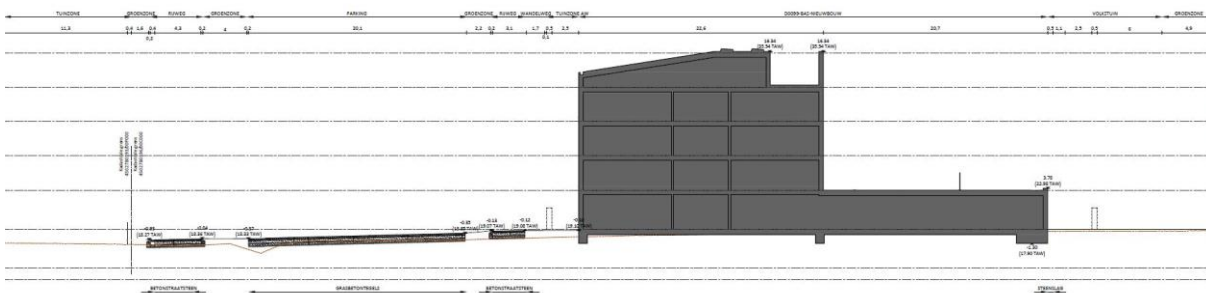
Plan van de geplande werken (bron: opdrachtgever).
